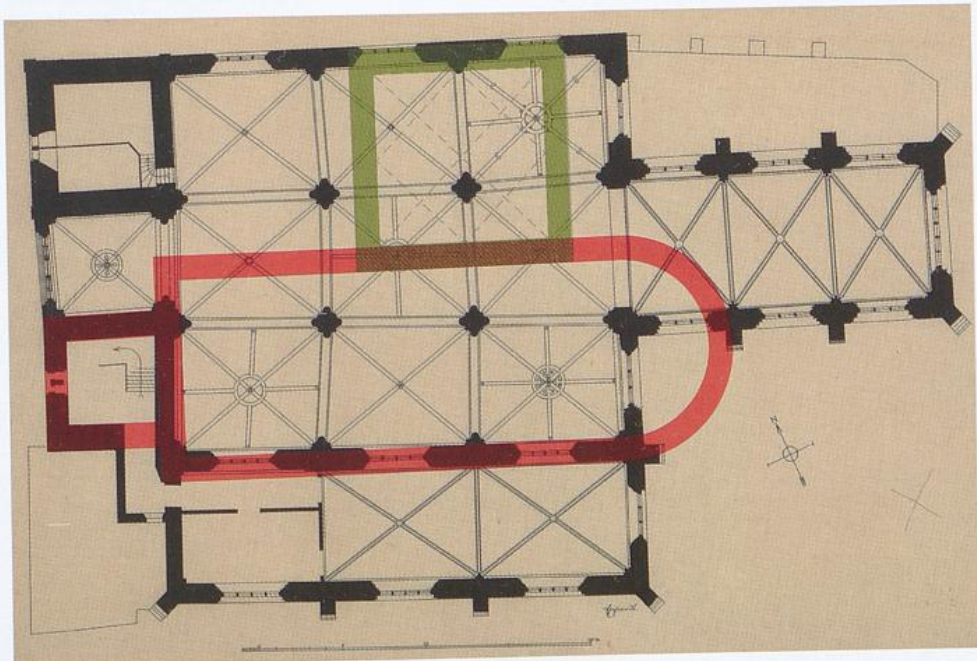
Unser Lieben Frauen, Grundriss Bau II mit Karner um 1100
